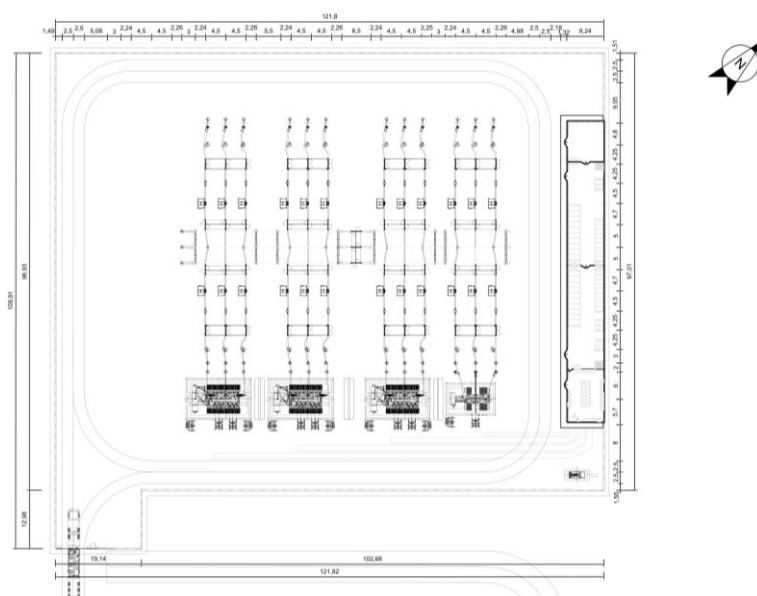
planta de la subestación eléctrica. Fuente: elaboración propia.
